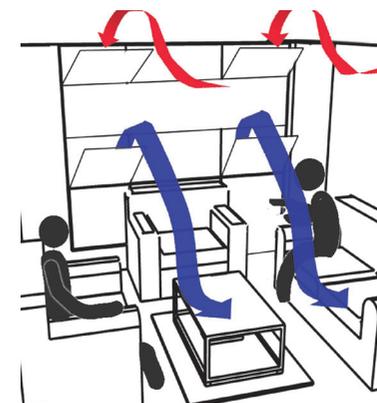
Esquema de ventilación natural por una fachada practicable
